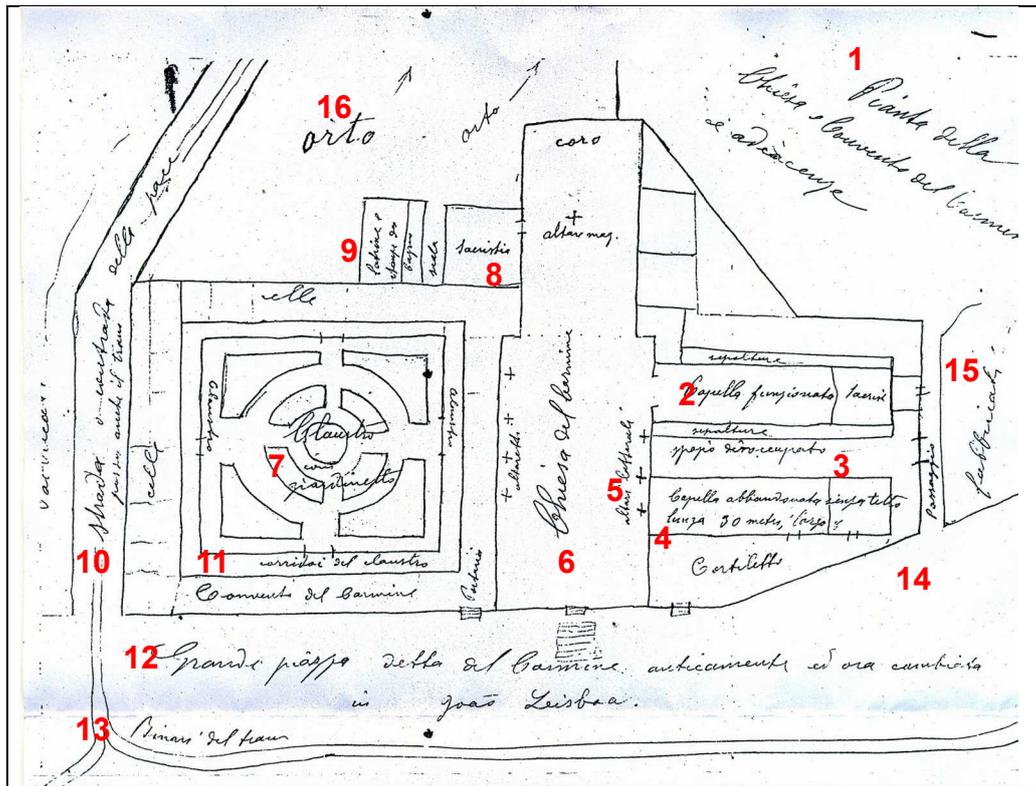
Levantamento do pavimento térreo do Carmo, 1917.
